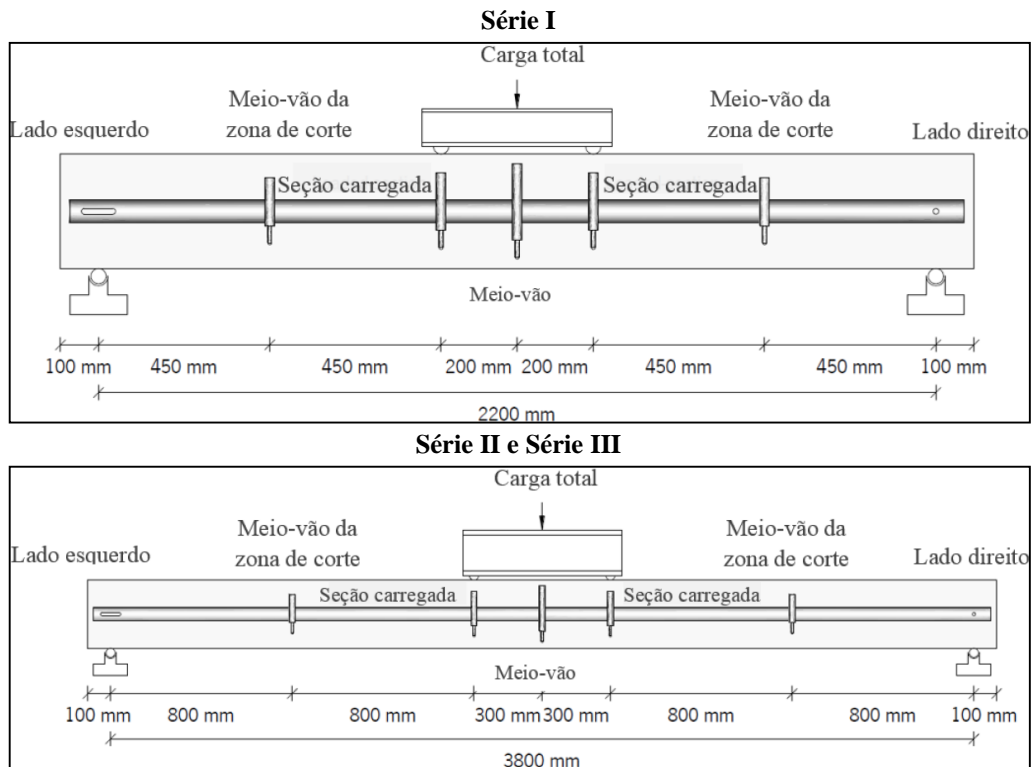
Sistema de ensaio das vigas ensaiadas por Costa (2014).
